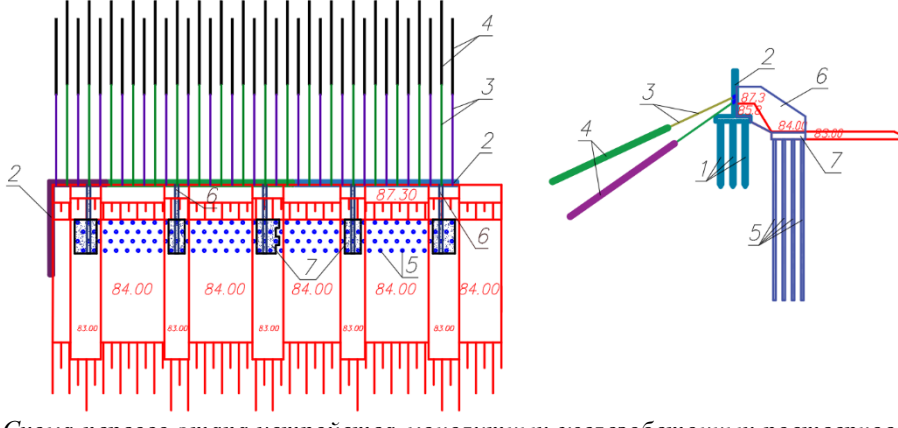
Вертикальная привязка свайных фундаментов в инженерно-геологический разрез: 1 – свайное основание из призматических железобетонных свай под существующий 2 монолитный железобетонный угловой ростверк; 3, 4 – грунтовые анкера ЭРТ (3 – анкерная тяга; 4 – корень анкера); 5 – буроинъекционные сваи ЭРТ усиления основания; 6 – монолитные железобетонные контрфорсы; 7 – монолитный железобетонный ростверк; 8 – пристенный линейный дренаж.
